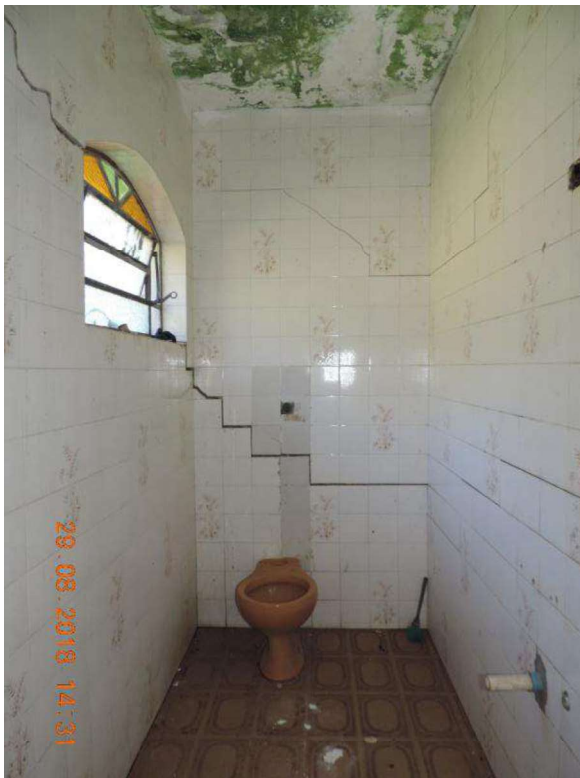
VISTA INTERNA DA CASA SEDE (BANHEIRO)
